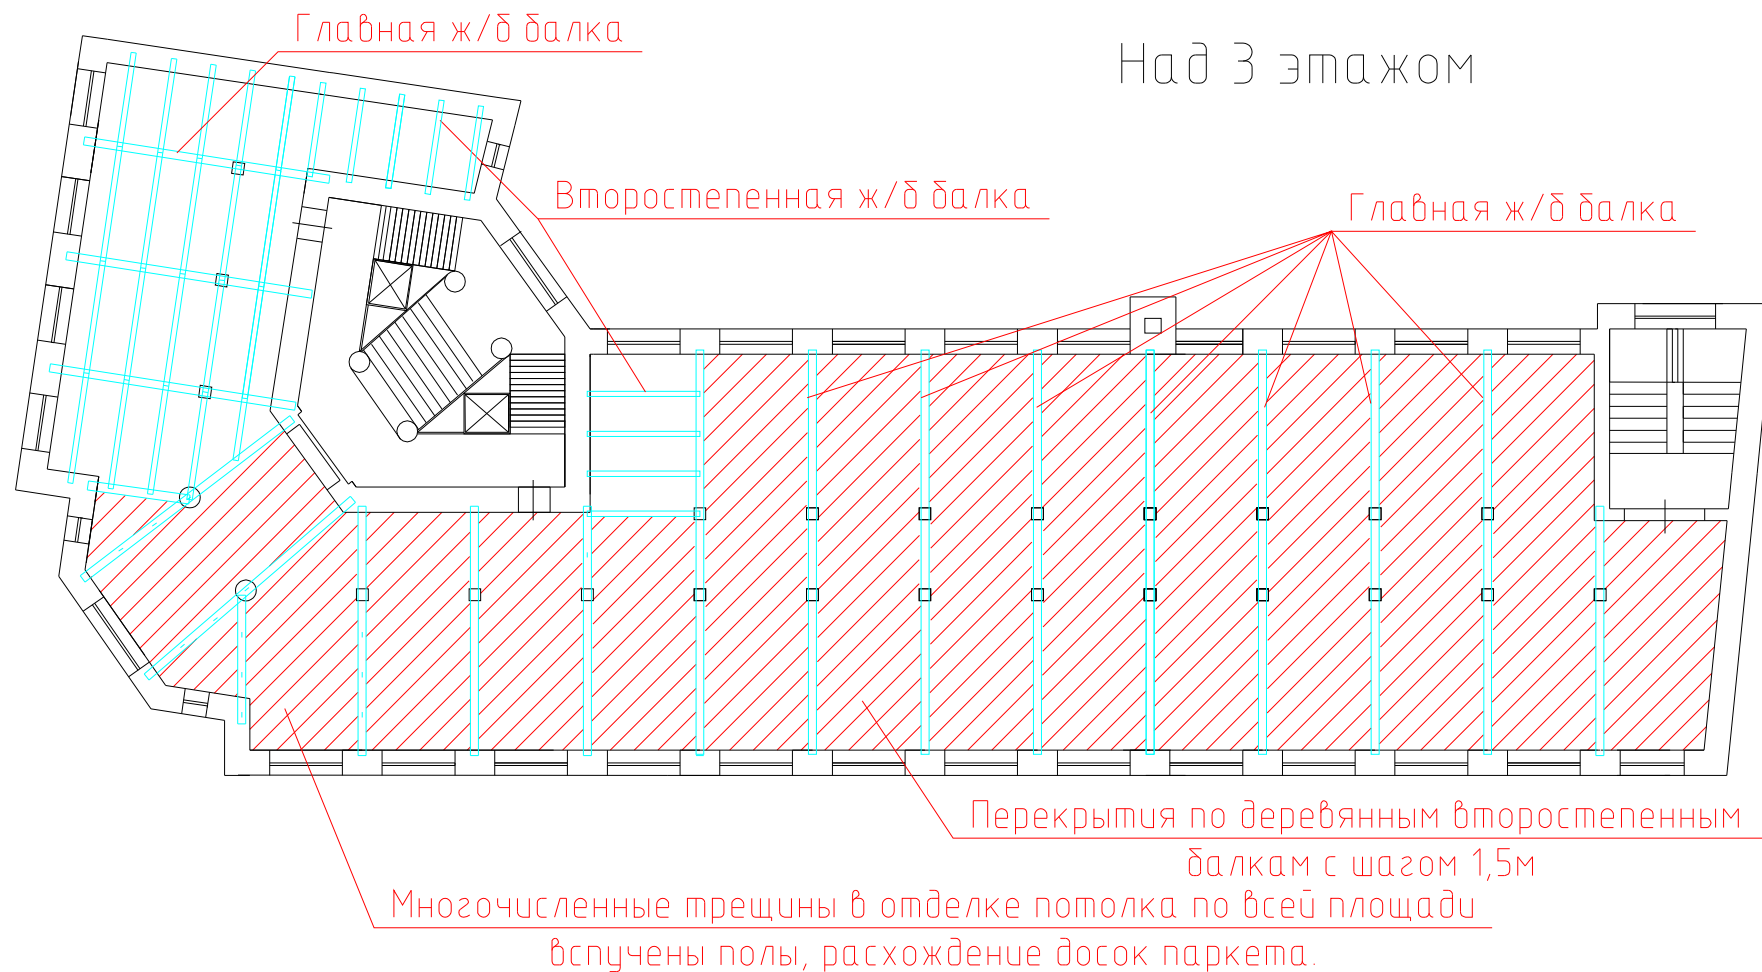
Схема главных и второстепенных балок монолитного ж/б перекрытия и деревянного перекрытия по главным ж/б балкам над третьим этажом
